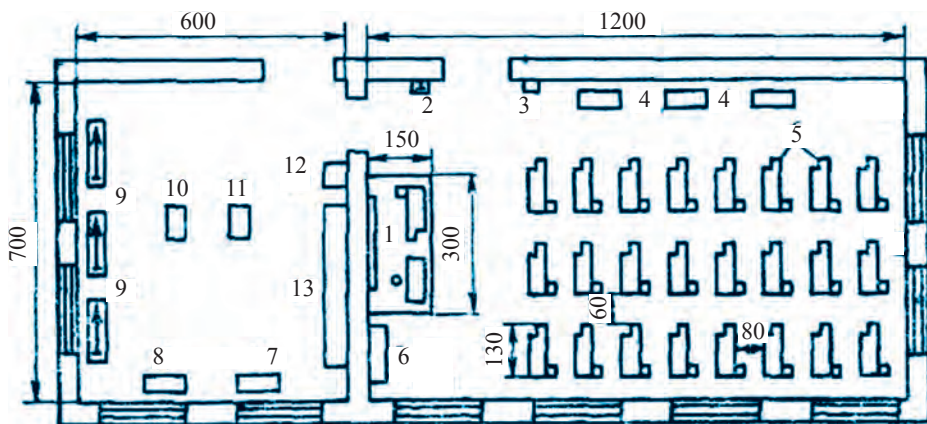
Примерный план расположения рабочих мест в столярных учебных мастерских: 1 – рабочее место учителя; 2 – умывальник для мытья руки; 3 – аптечка; 4 – шкаф для принадлежностей и материалов; 5 – колода; 6 – станки; 7 – настенные часы; 8 – шкаф для учебно-наглядных пособий; 9 – красильный стол; 10, 11, 12, 13, 14 – фрезерные, сверлильные, токарные станки для обработки дерева, строгальные, распиловочные станки; 15 – точильный станок; 16 – полка для материалов.
